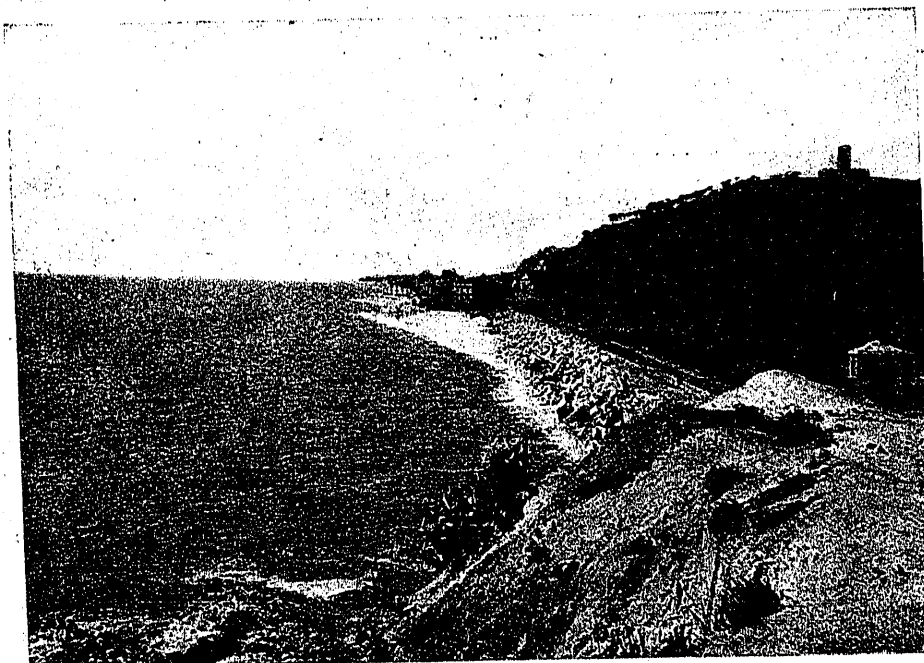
ª — Defensa longitudinal de escollera en Arenys de Mar.
